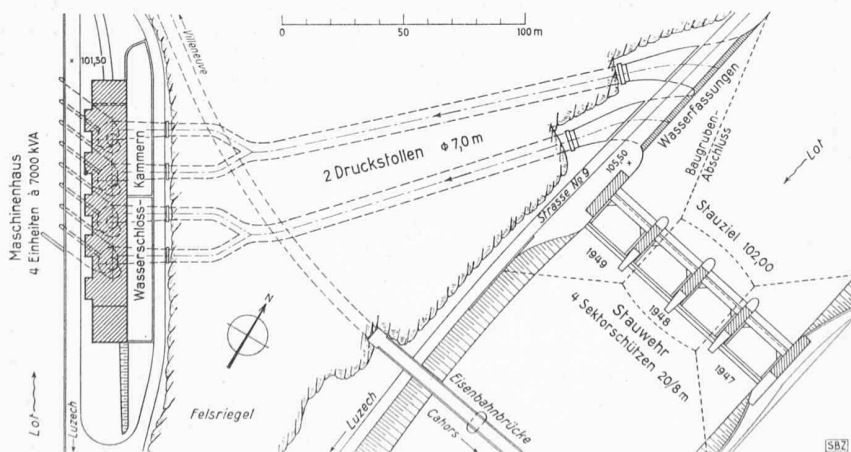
Kraftwerk Luzech am Lot (Frankreich), Lageplan 1 : 3000
